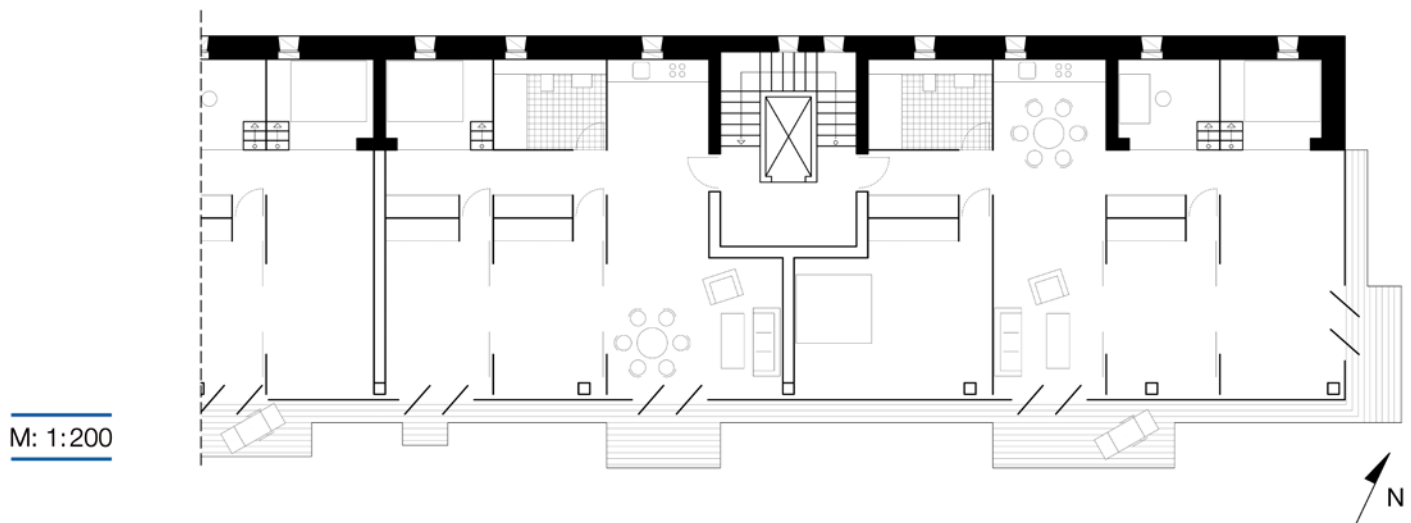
Typenentwurf »Zeilenbau« in Ortbetonbauweise, Grundriss Regelgeschoss
